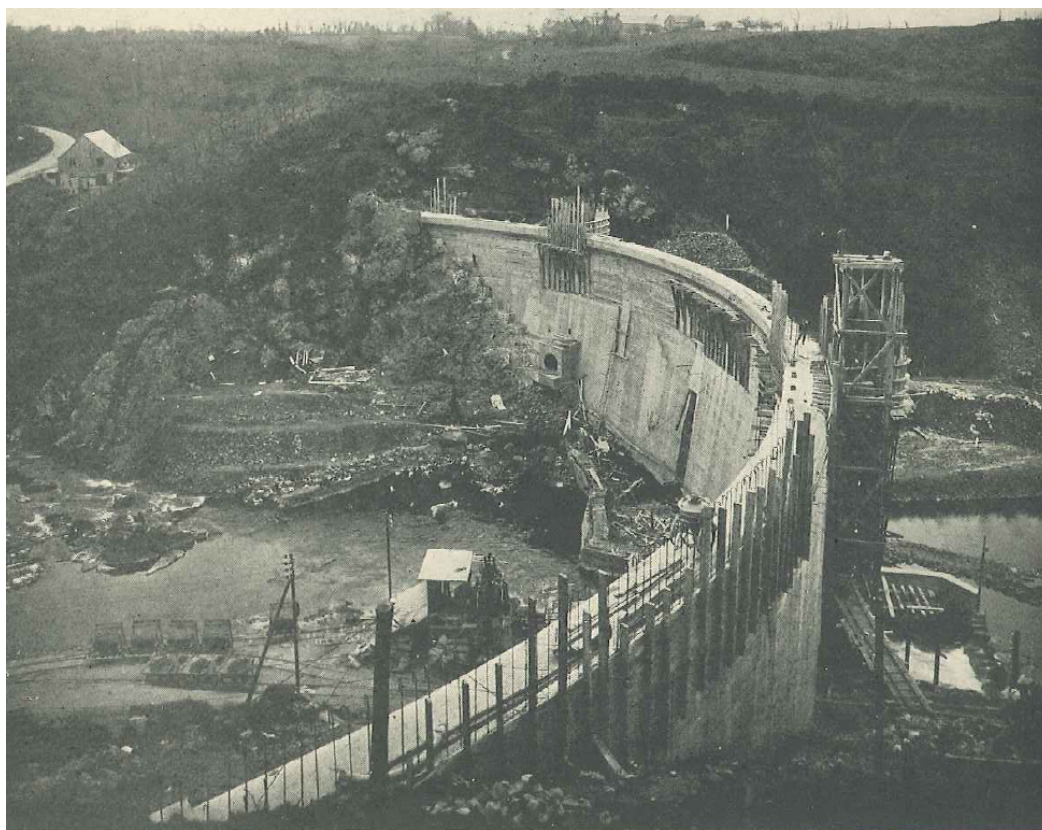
Construction du barrage de Pont Rolland⁽¹⁾
